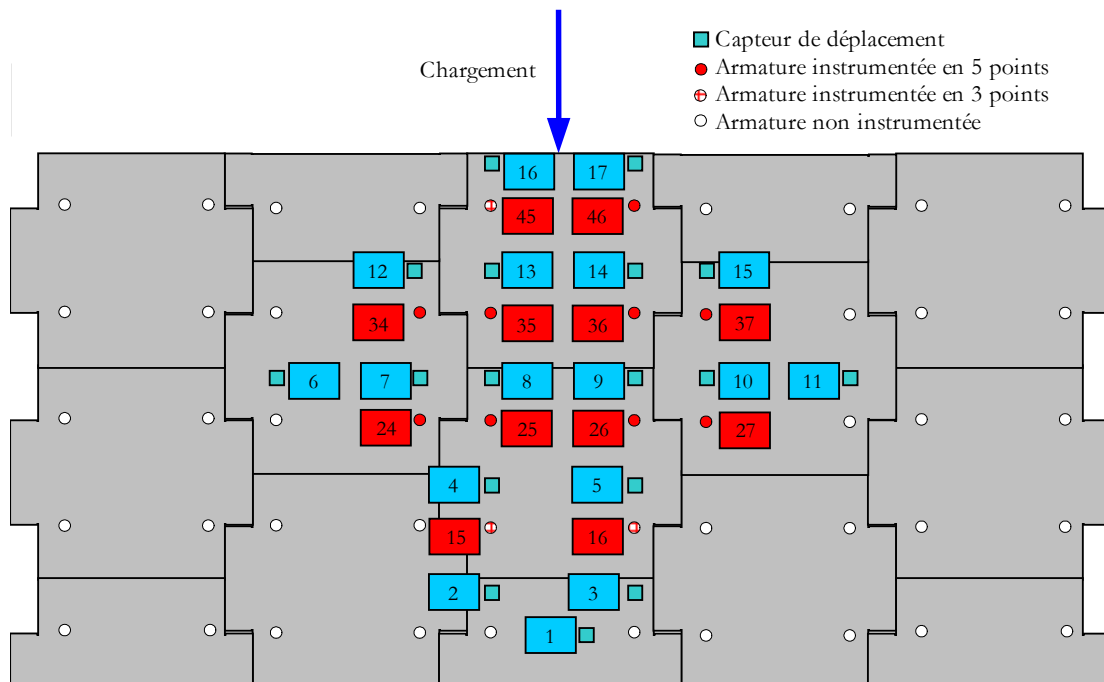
Plan d'instrumentation : Vue du parement (d'après Froumentin et al., 2008).
